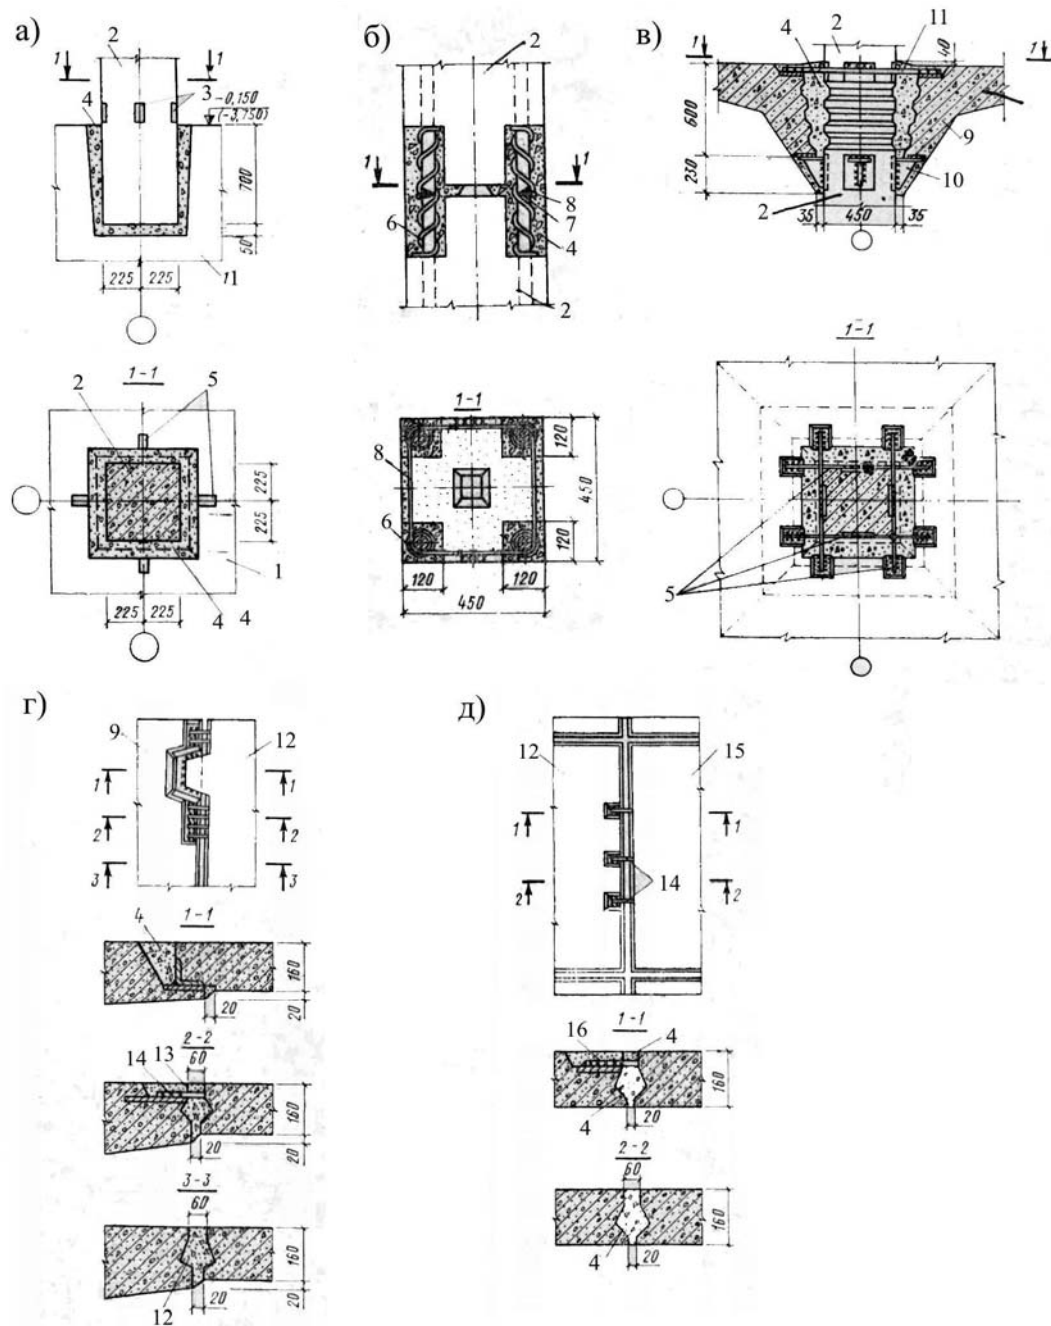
Сопряжение элементов каркаса с безбалочными перекрытиями:
